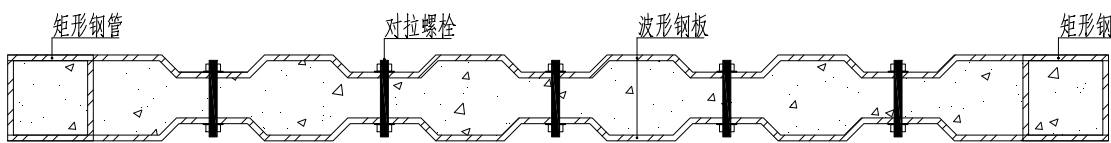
波形钢板混凝土组合剪力墙构造示意图
